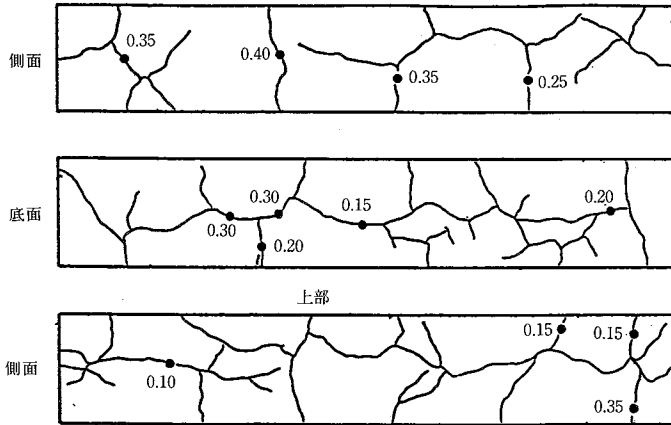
アルカリシリカ反応によってコンクリート試験体に生じたひびわれ状況の1例 (図中の数字はひびわれ幅, 単位mm)
